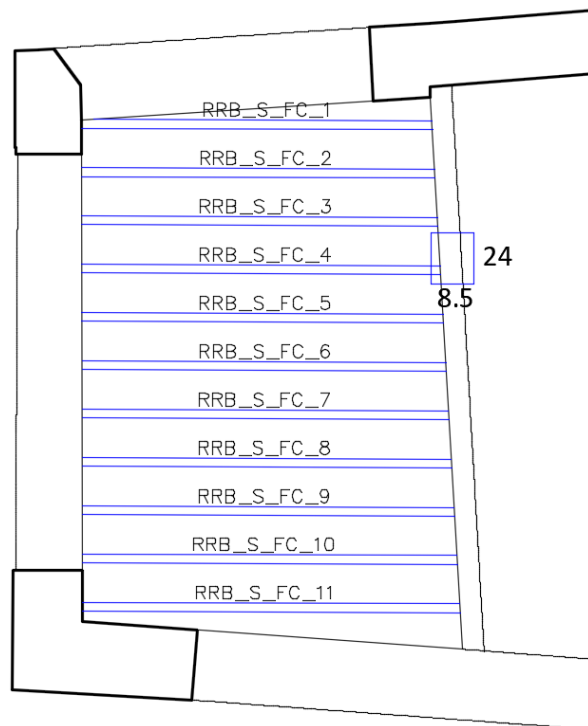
Detalle de ubicación de vigas en zona 3. Forjado de planta 1ª.
